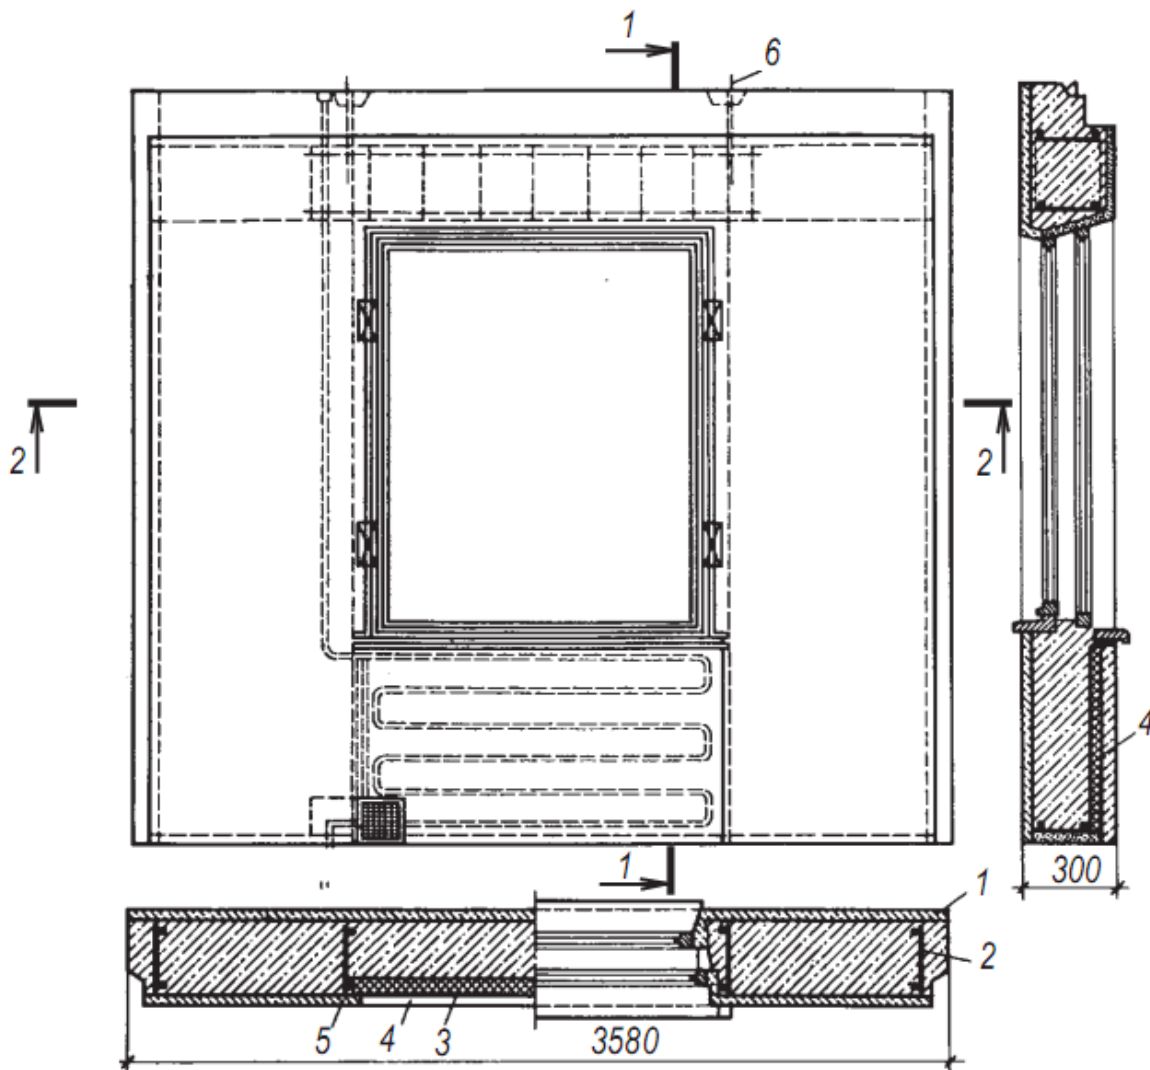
Одношарова стінова панель: 1 – зовнішній декоративний (захисний шар); 2 – арматурний каркас; 3 – утеплювач; 4 – панель опалення; 5 – внутрішній опоряджувальний шар; 6 – монтажна петля
